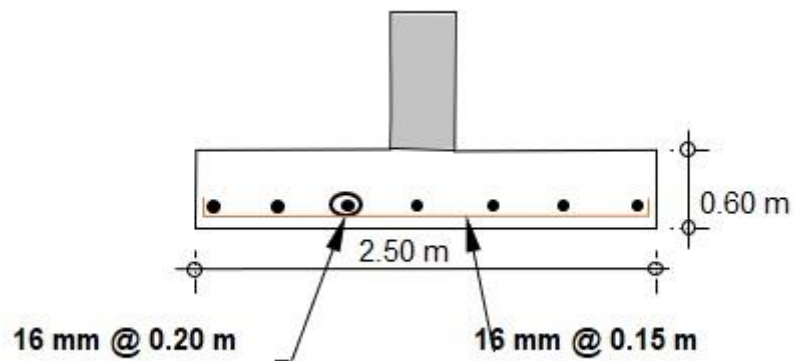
Armado de la zapata (Vista lateral) Fuente: Propia
